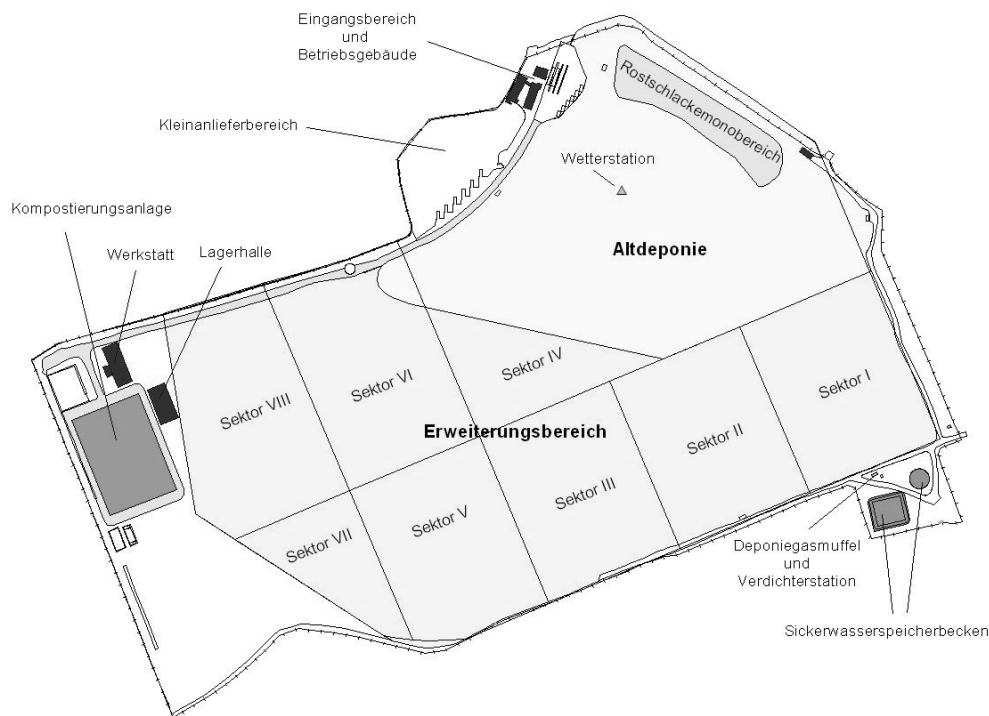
Lageplan der Deponie „Kirschenplantage“
